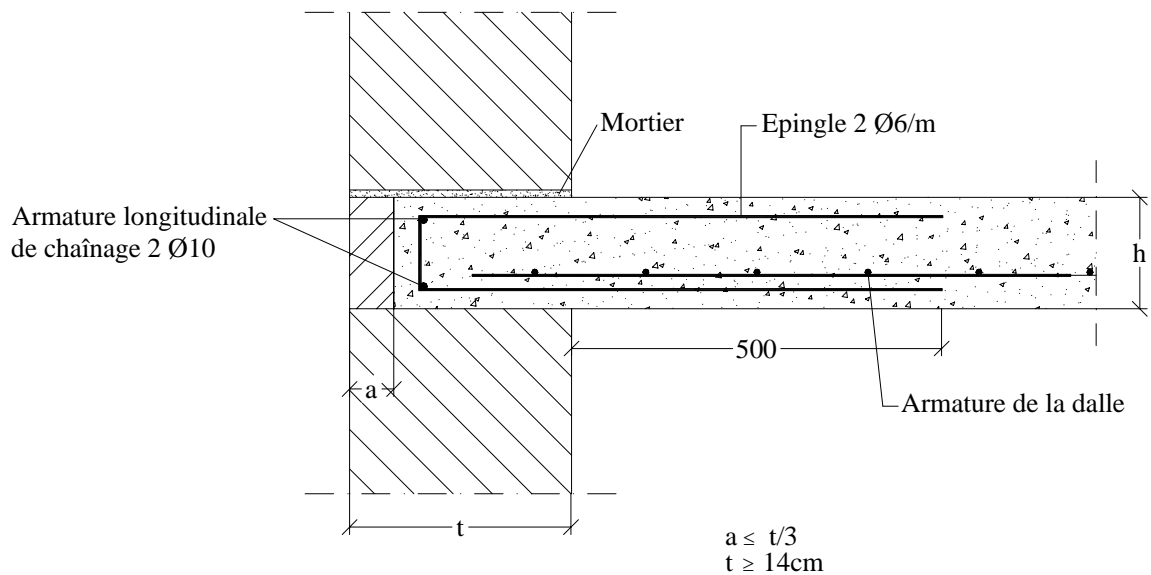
Liaison entre un plancher en dalle de béton coulé sur place et un mur d'appui. Cas du mur massif.
